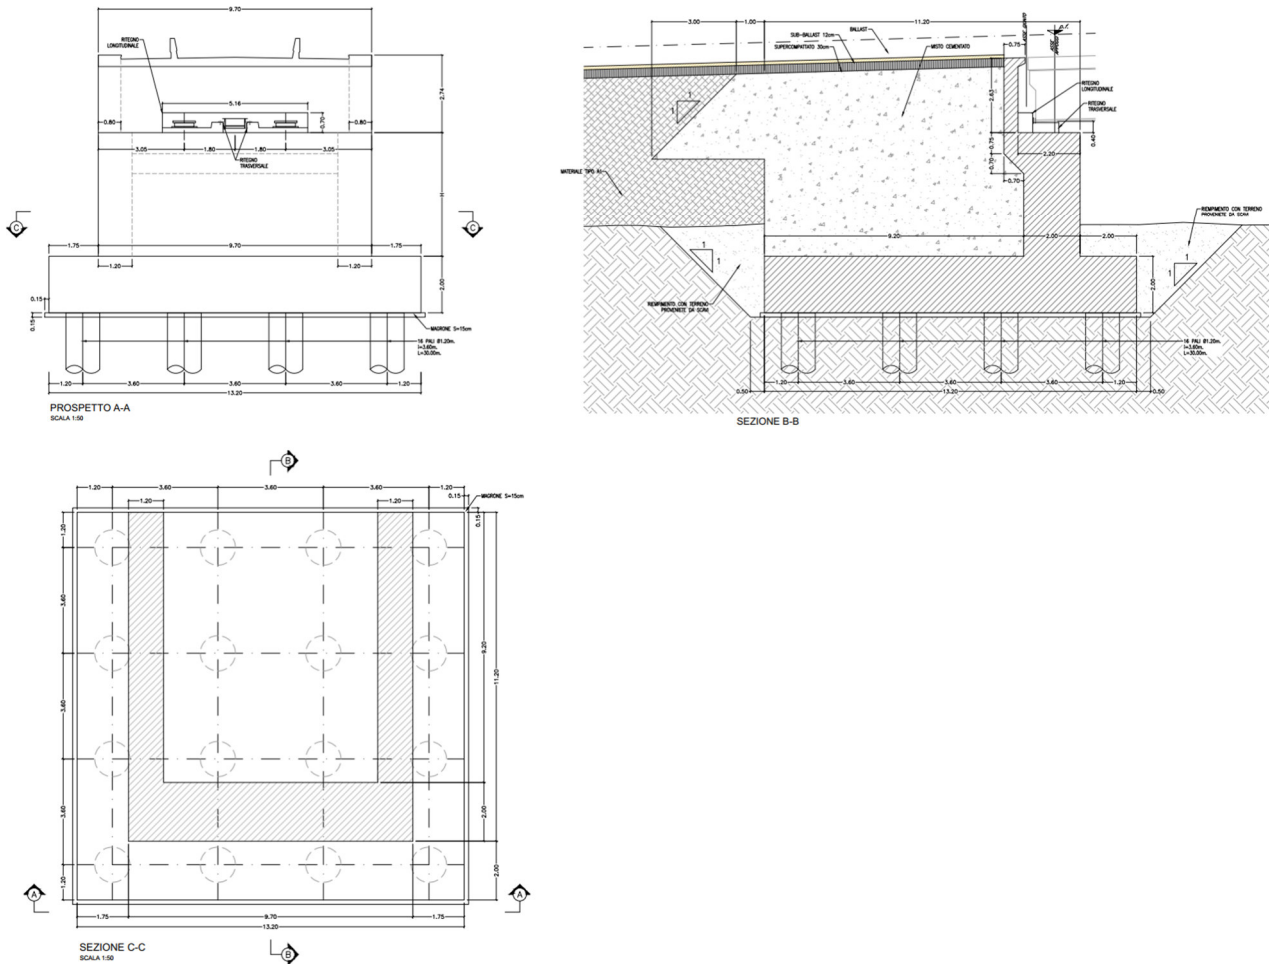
Prospetto e sezioni spalle VI01 [m].
